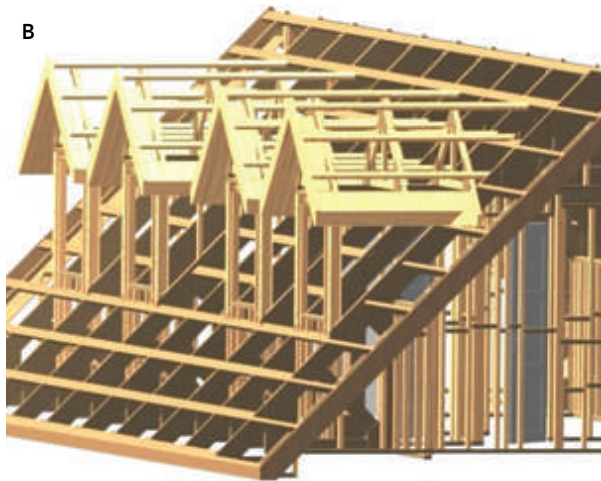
76: Lucarna a un agua que interrumpe los elementos estructurales del diafragma inclinado y que requiere de refuerzos en el perímetro donde se recortaron las piezas de la estructura de techumbre.
